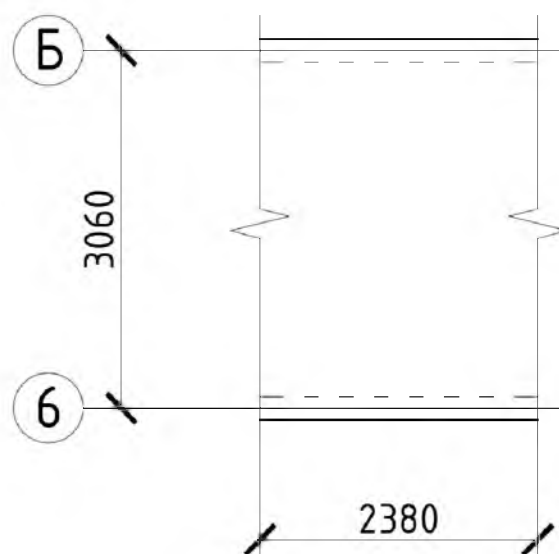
Схема рассчитываемого фрагмента перекрытия на отметке + 3,060
